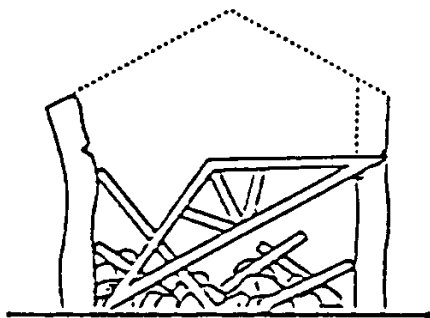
Une cause additionnelle de fissuration entre murs: les entailles constructives
